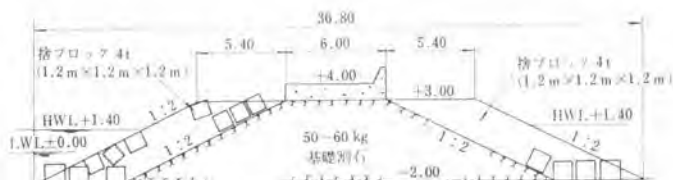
(A) 捨石堤標準断面図 (A区間 118.1 m)
